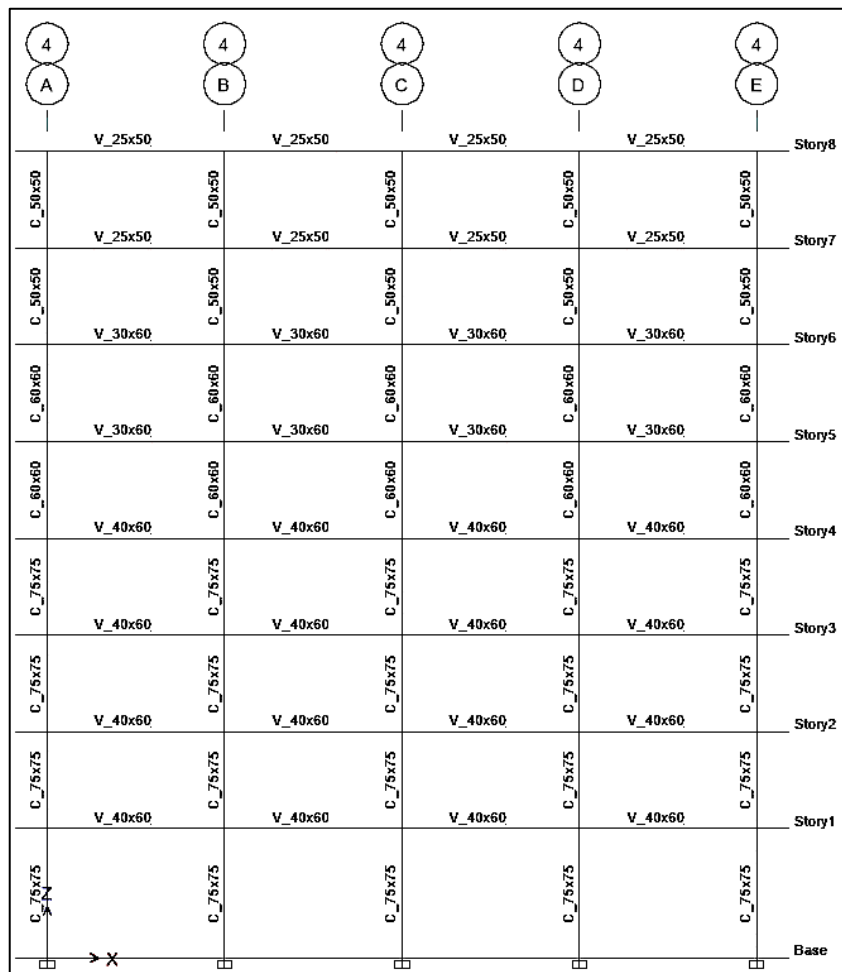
Elevación Pórtico interior eje 4 de la estructura final
